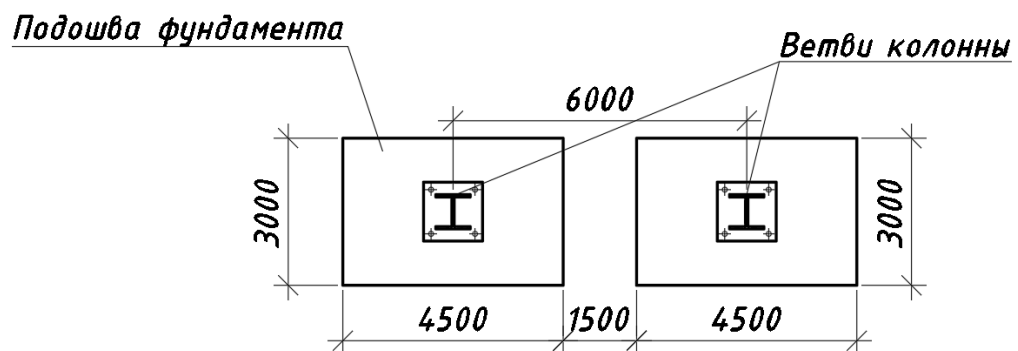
Схема конструирования столбчатого фундамента под ветви колонн
